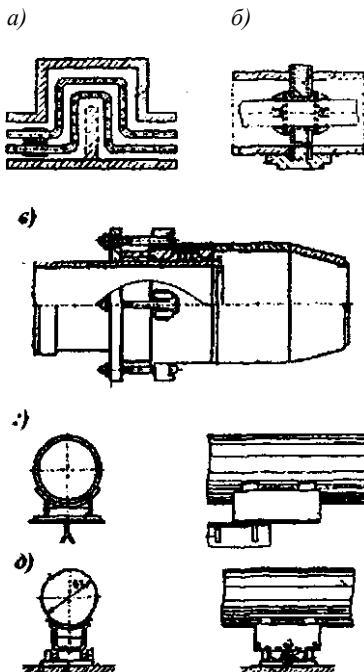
Конструктивные элементы тепловых сетей: а - размещение компенсатора в нише; б - неподвижная щитовая опора; в - сальниковый компенсатор; г - скользящая опора; д - катковая опора
